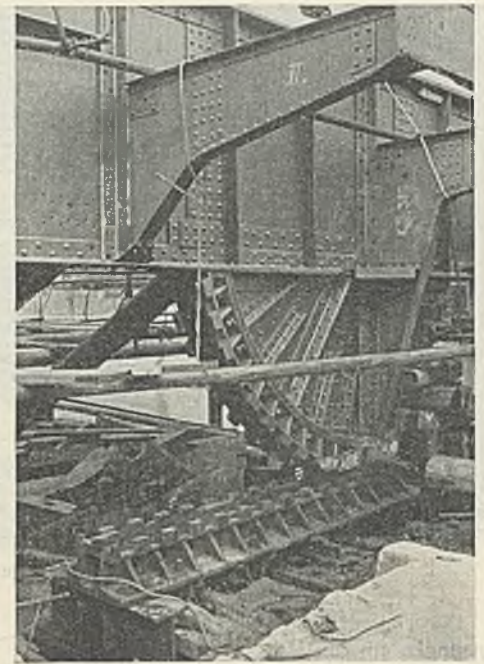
„Kreissektor“, auf dem die Rollklappbrücke beim Öffnen und Schließen rollt.
